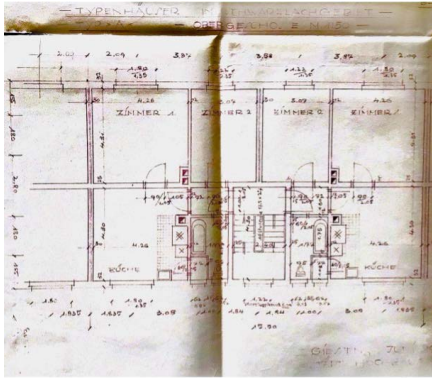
StdtAG N 1517, Grundriss Typ A, Juni 1929
